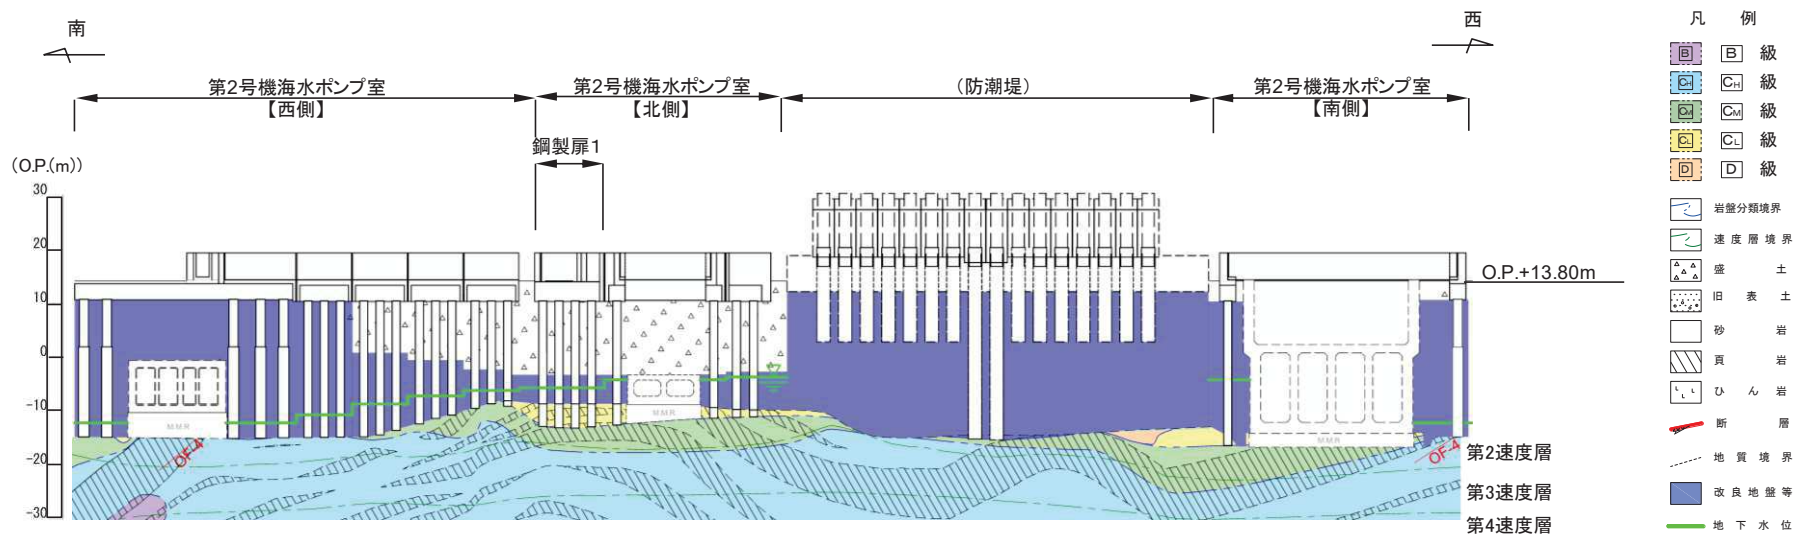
(1) 鋼製扉周辺の地質状況 (第2号機海水ポンプ室)
